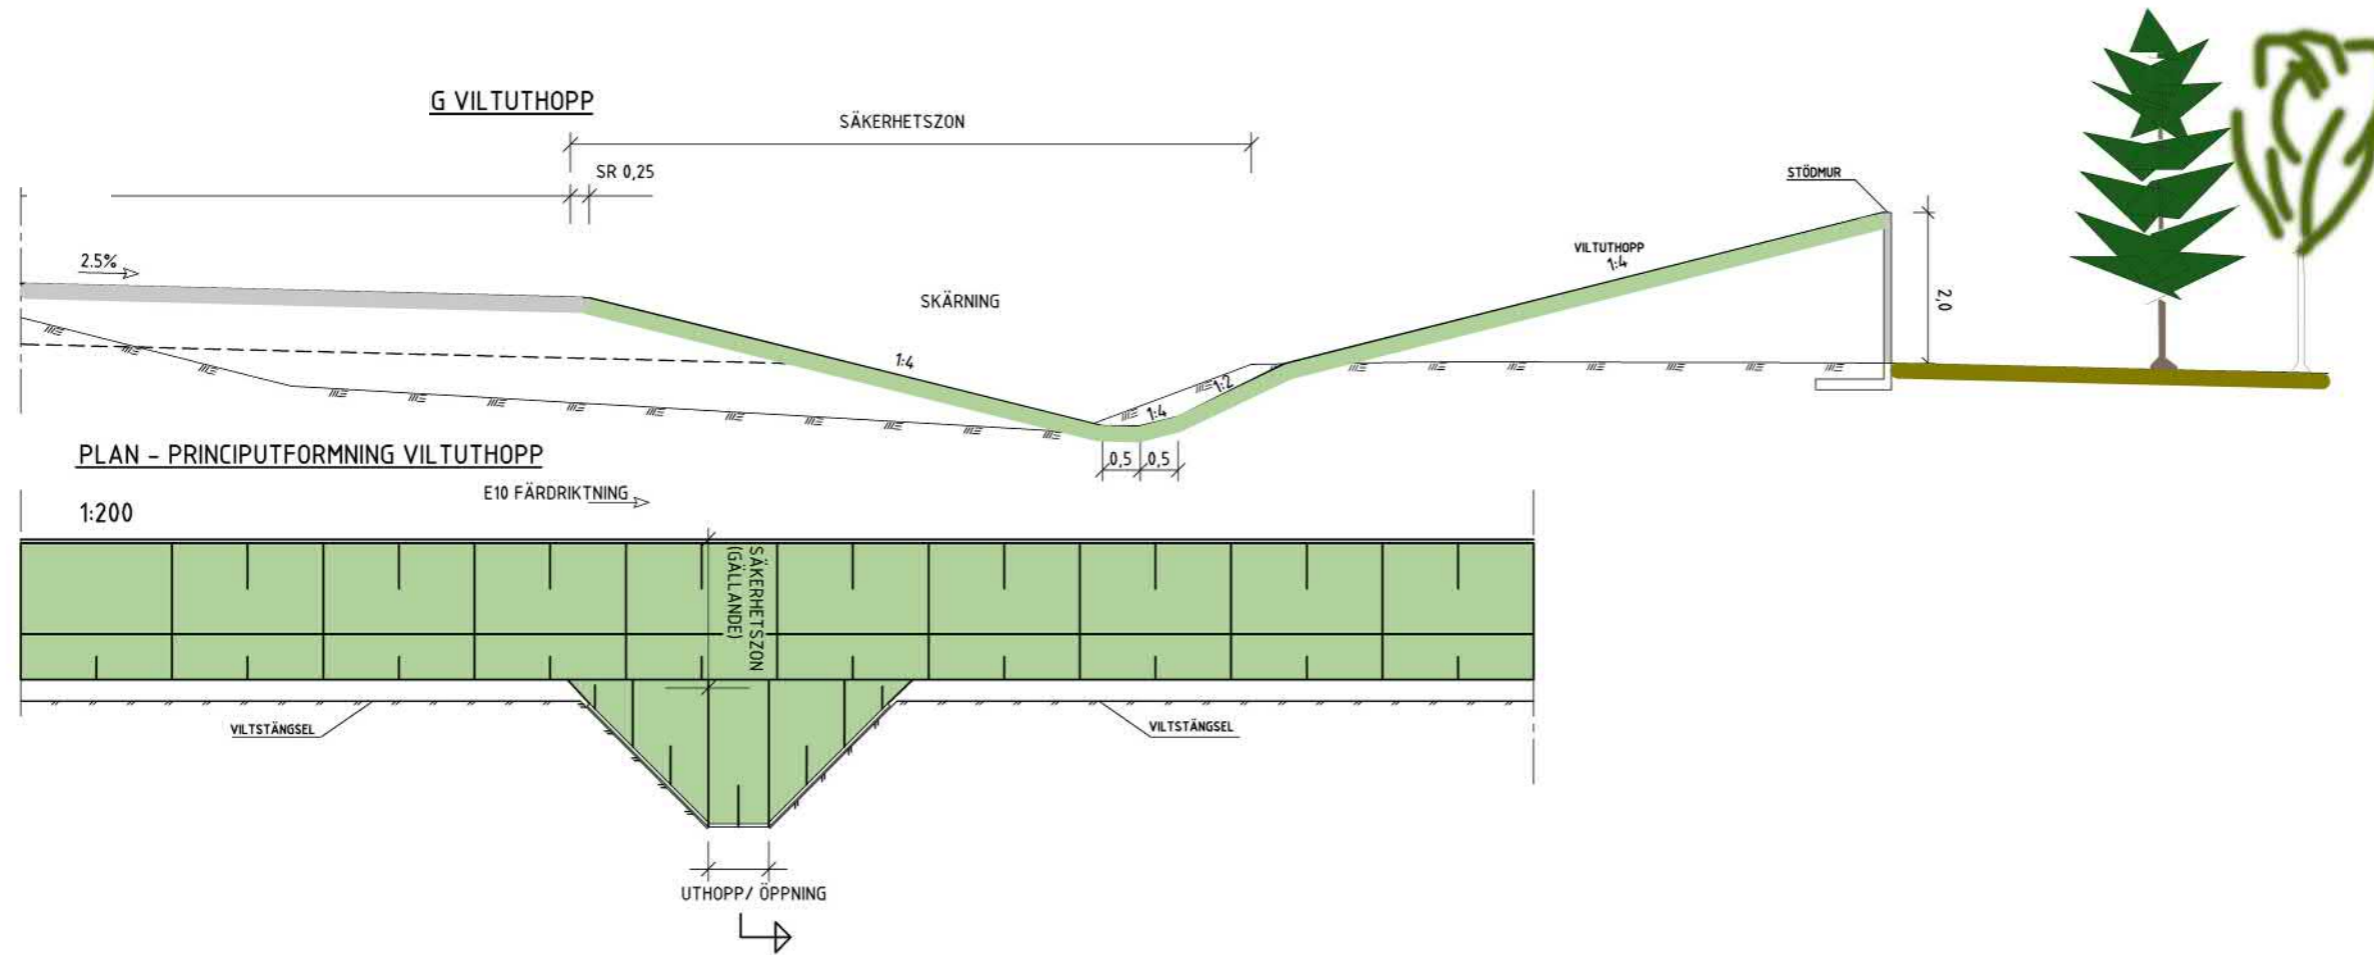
Viltuthopp i plan och sektion.
